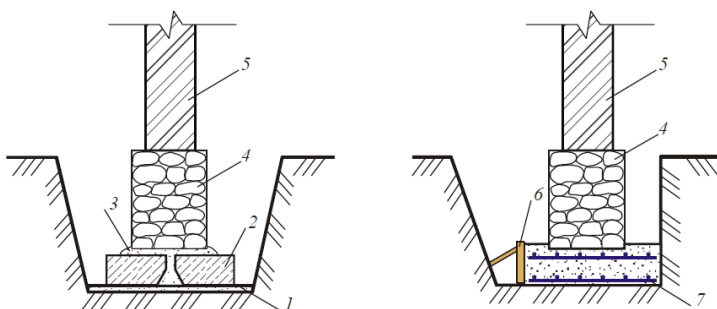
Уширение подошвы фундамента: *а* – подводкой железобетонных плит; *б* – устройством монолитной железобетонной подушки: 1 – уплотненная грунтовая подготовка; 2 – железобетонные плиты; 3 – цементно-песчаный раствор; 4 – фундамент; 5 – стена; 6 – опалубка; 7 – арматурная сетка
